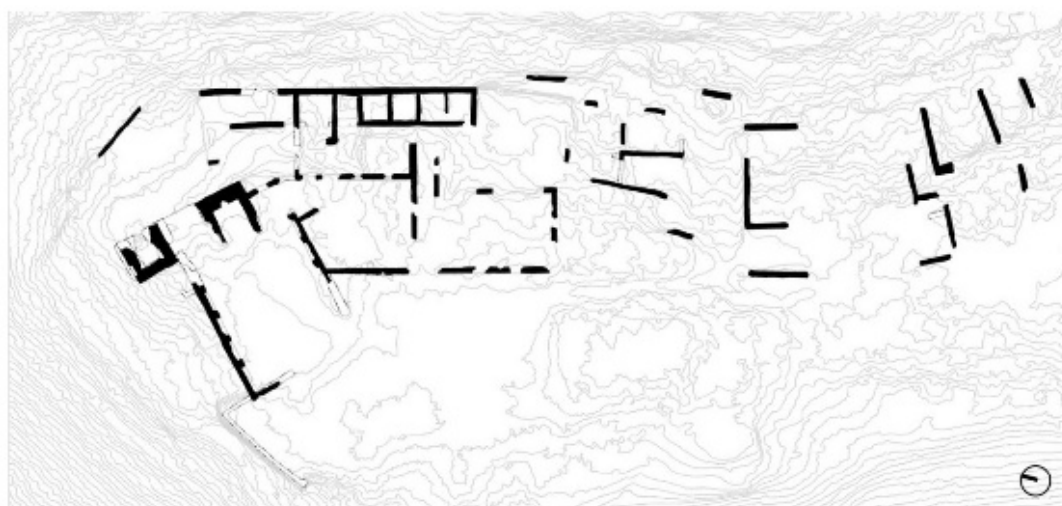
Restituzione grafica dello sviluppo planimetrico di Gioiosa Guardia.
